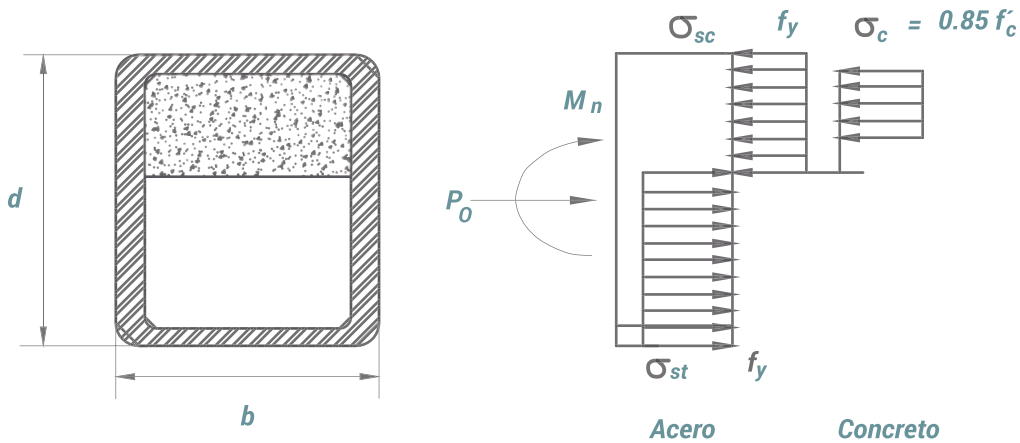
Distribución plástica de esfuerzos en tubos columnas c.
